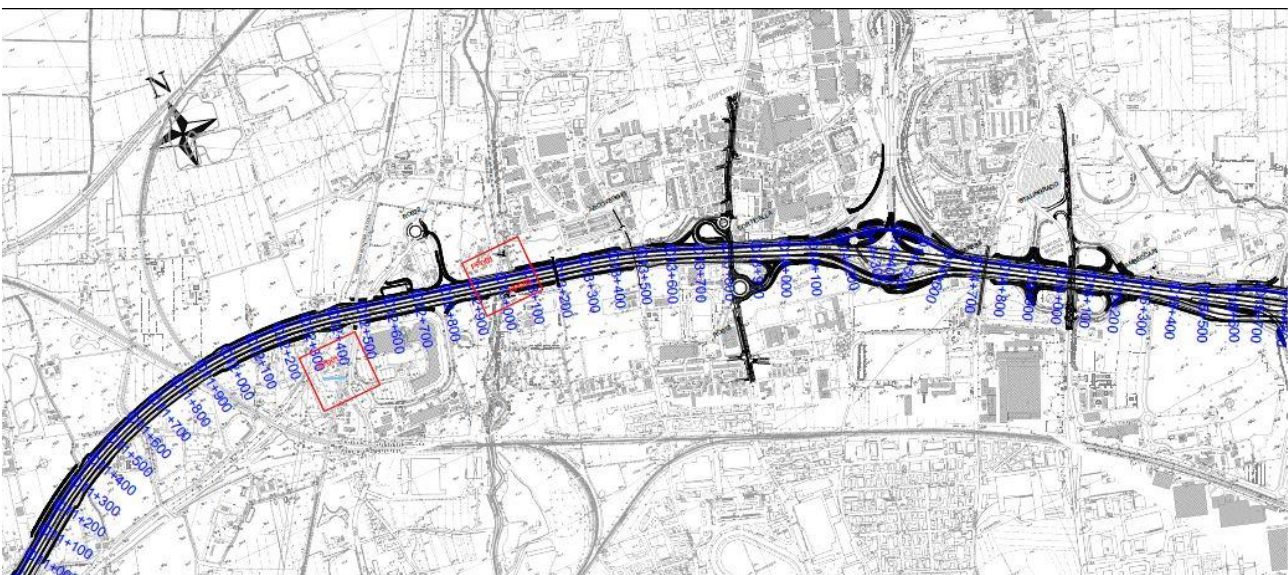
Planimetria dell'area di intervento (parte 2) (in rosso le principali opere connesse ricadenti nel Lotto 1).
